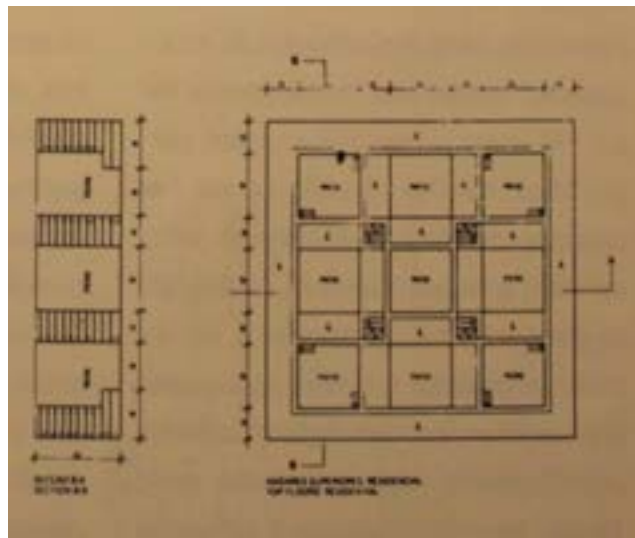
Proposta de Siza Vieira para a Areia Preta; Proposta de bairro. Plano de Urbanização de Macau, NAPE. (1983) (Siza Vieira, 1990, p. 27)
